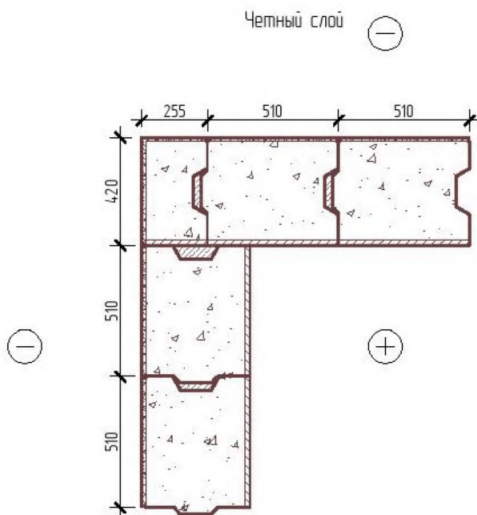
Кладка наружных углов стен из керамзитобетонных блоков
